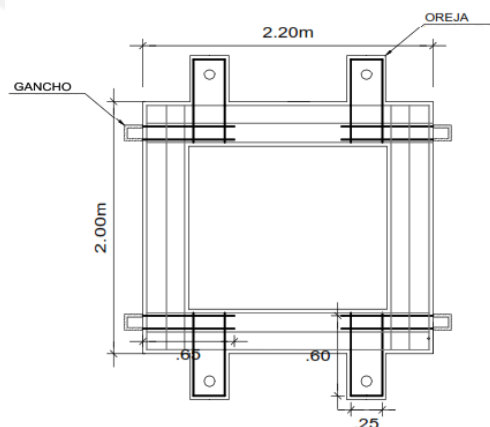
Ubicación de ganchos y orejas en la viga de cimentación
